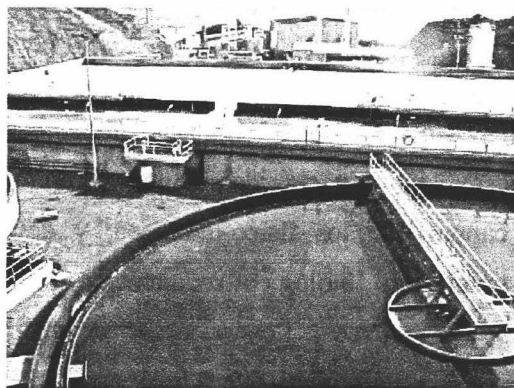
Vista general de la planta de fangos activos de la empresa DSM DERETIL S.A. en Villaricos (Almería).
